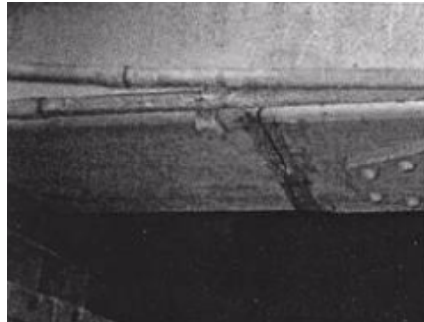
Lesione a fatica in una saldatura di testa sulla flangia inferiore [2].
